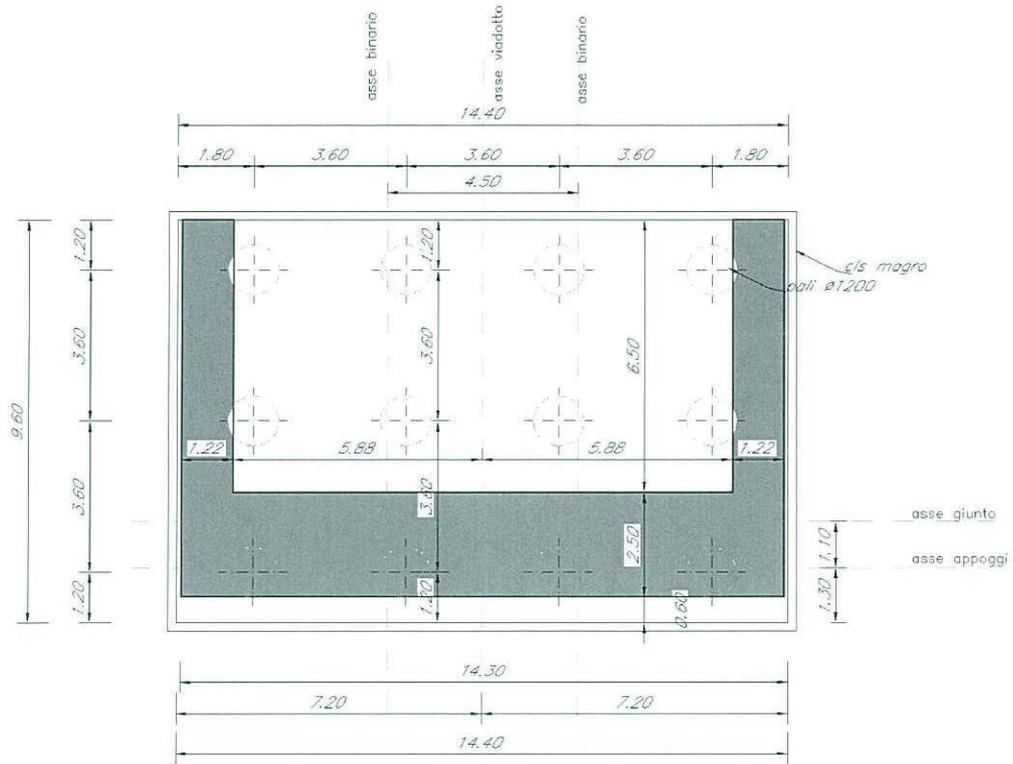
Pianta fondazioni della spalla tipo.
